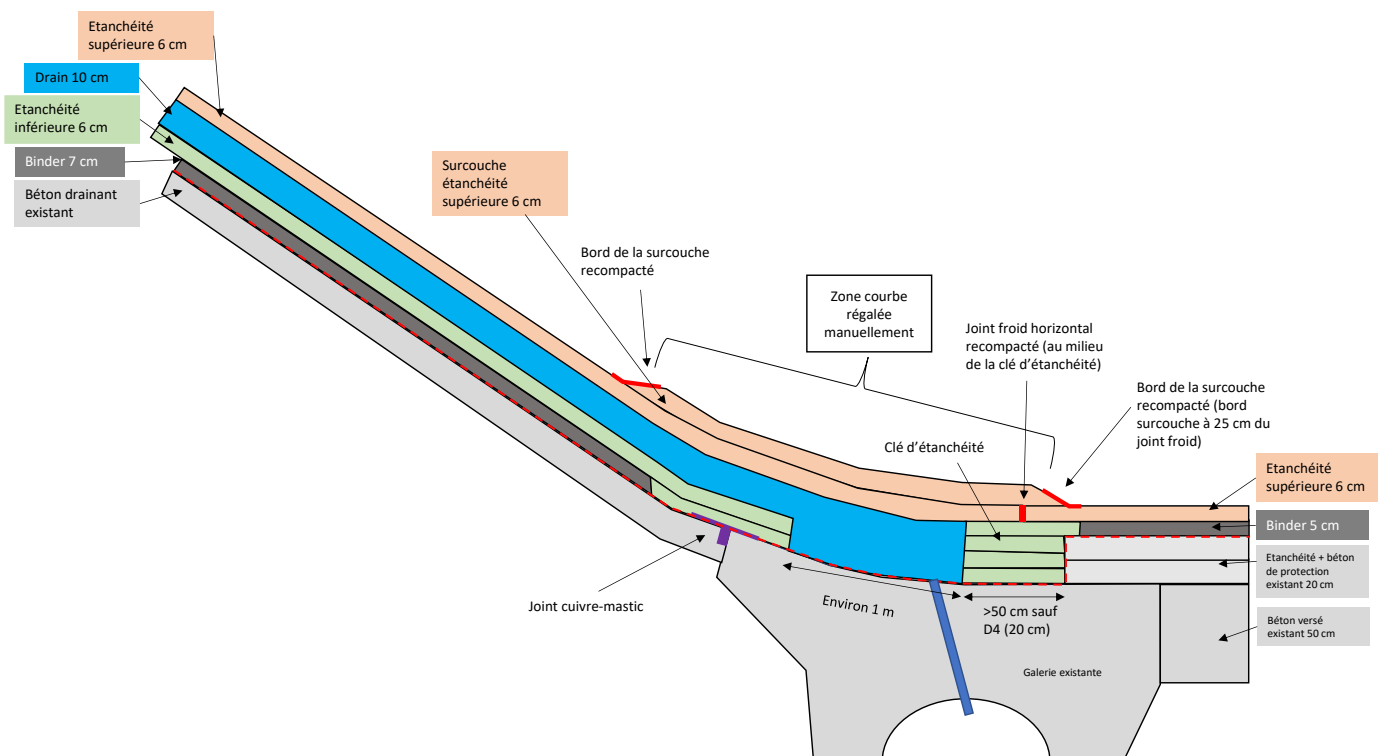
Mise en place de la couche drainante sur la couche d'étanchéité inférieure
